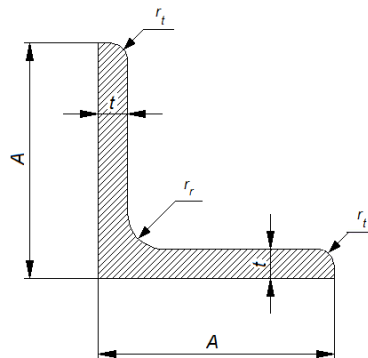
Sección transversal de las columnas (Fuente: Propia, 2015).
